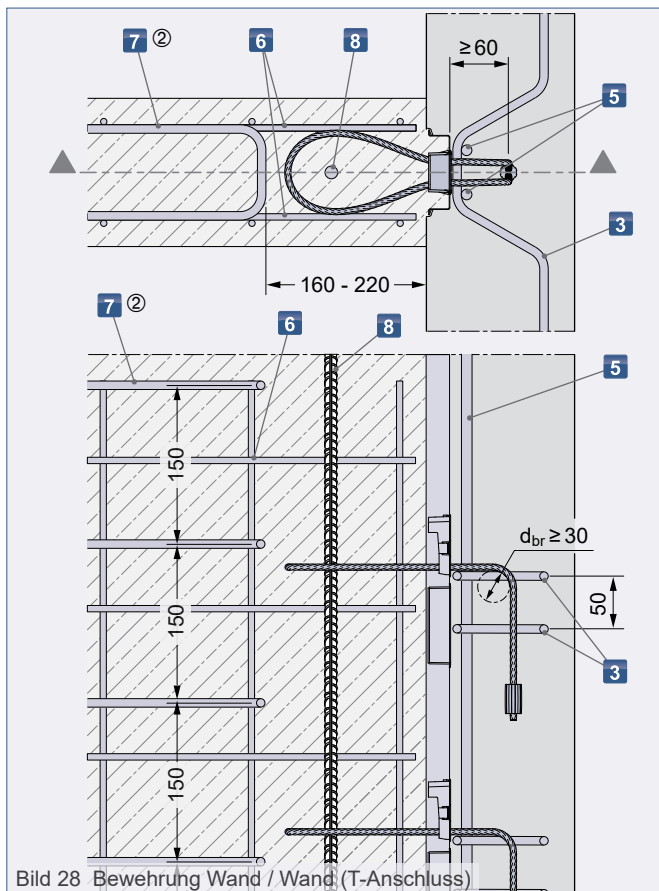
Bewehrung Wand / Wand (T-Anschluss)
